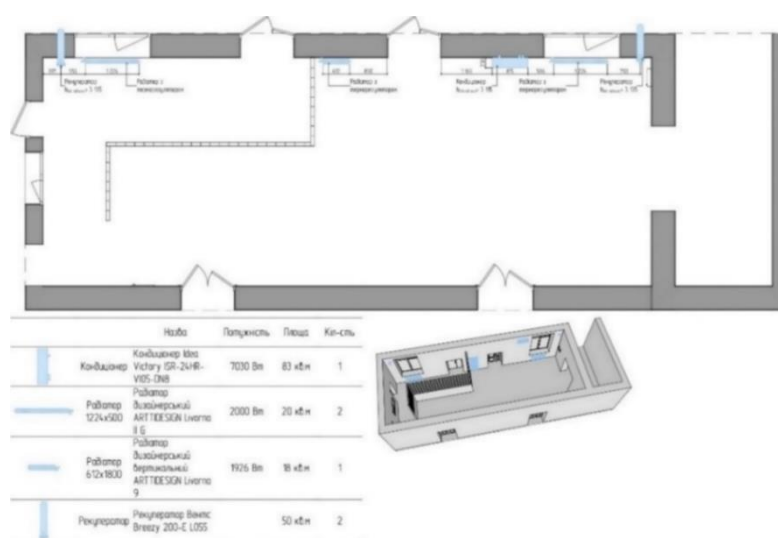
Схема плану опалення, вентиляції та кондиціонування
